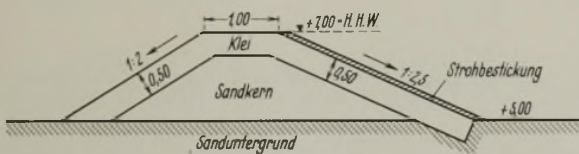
Querschnitt durch den Baugrubenschutzdeich.
